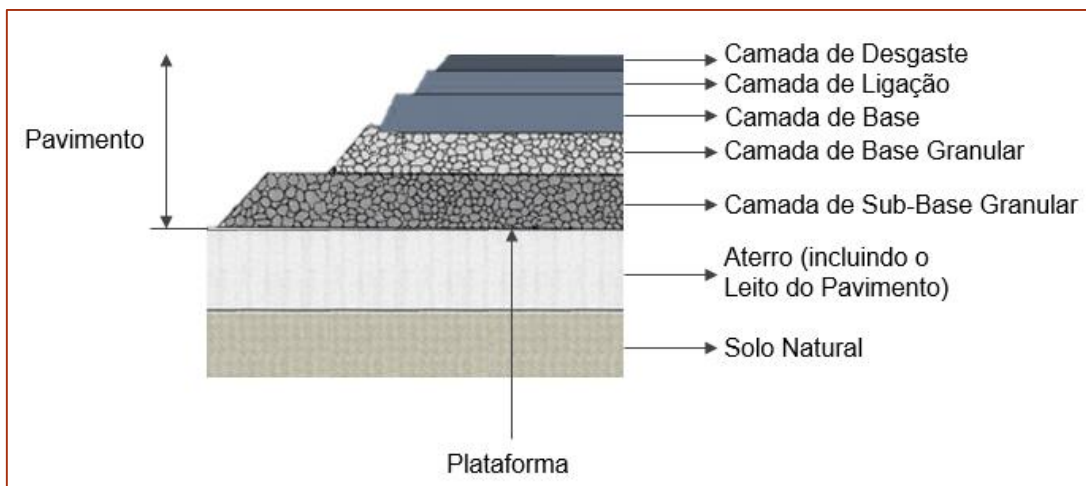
Diagrama esquemático da estrutura de um pavimento rodoviário (adaptado de Azevedo, M.C., 2009)
